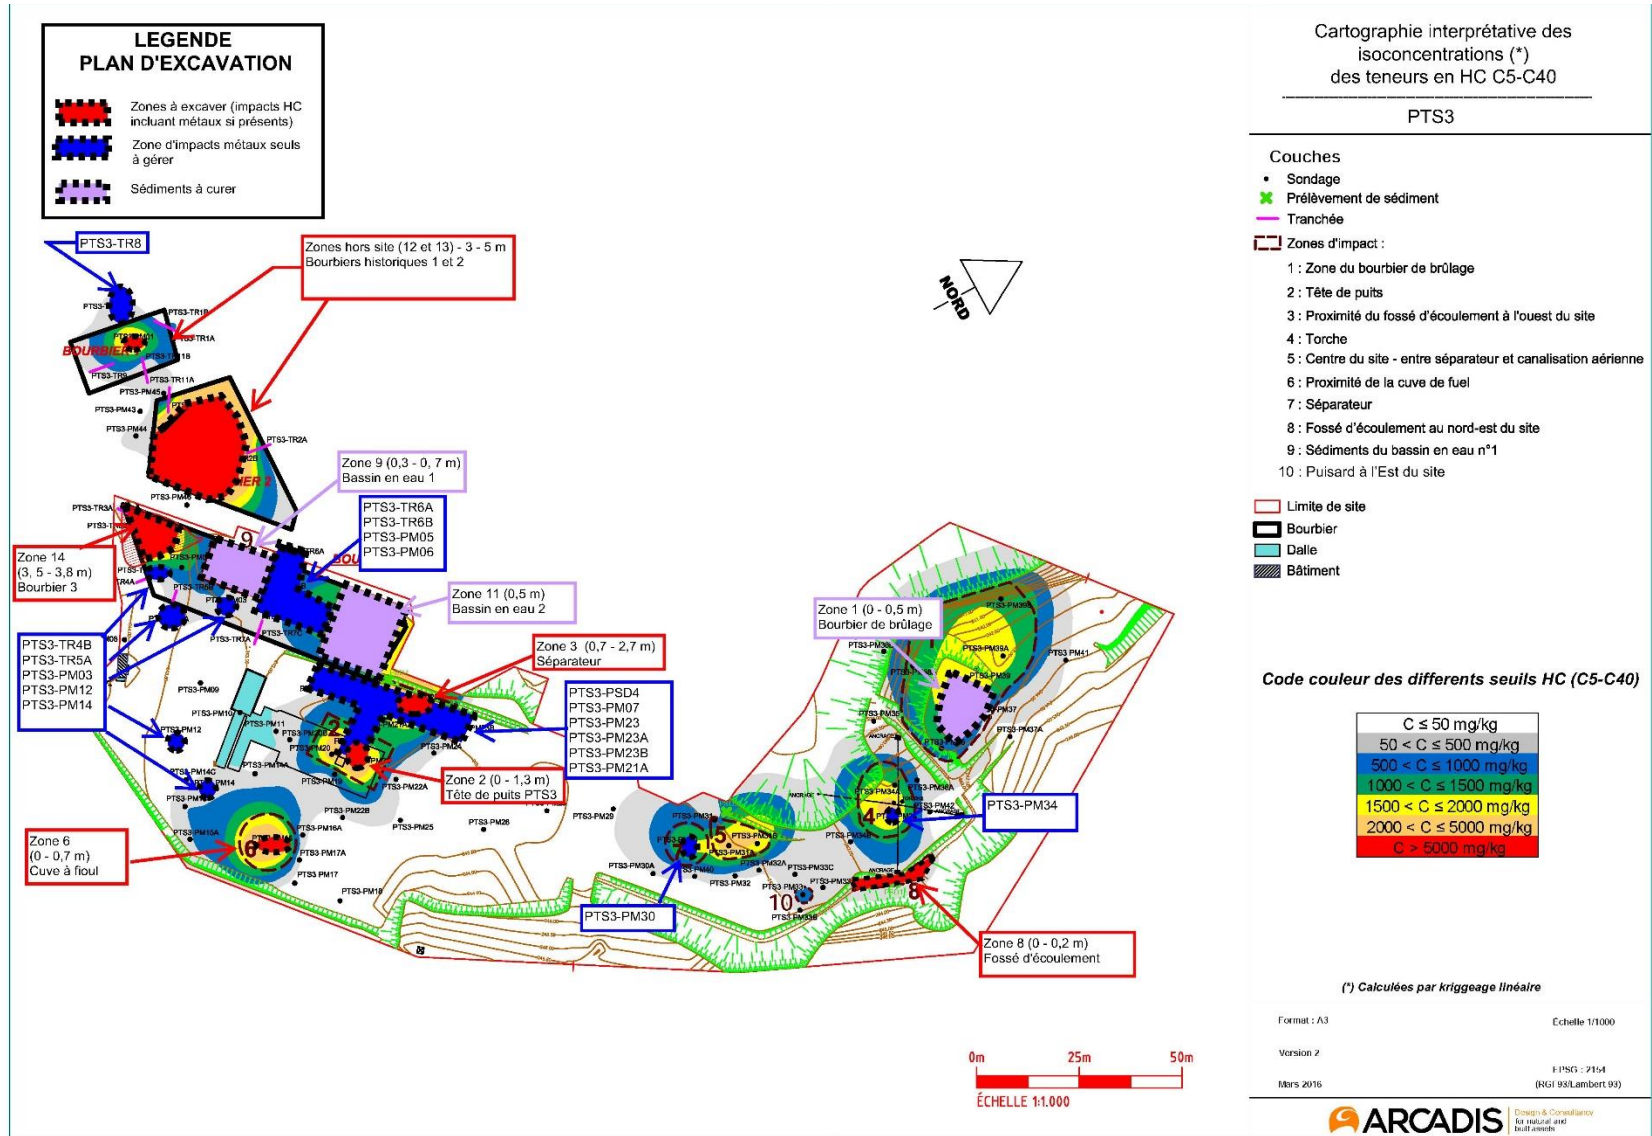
Plan d'excavation prévisionnel du site PTS3
